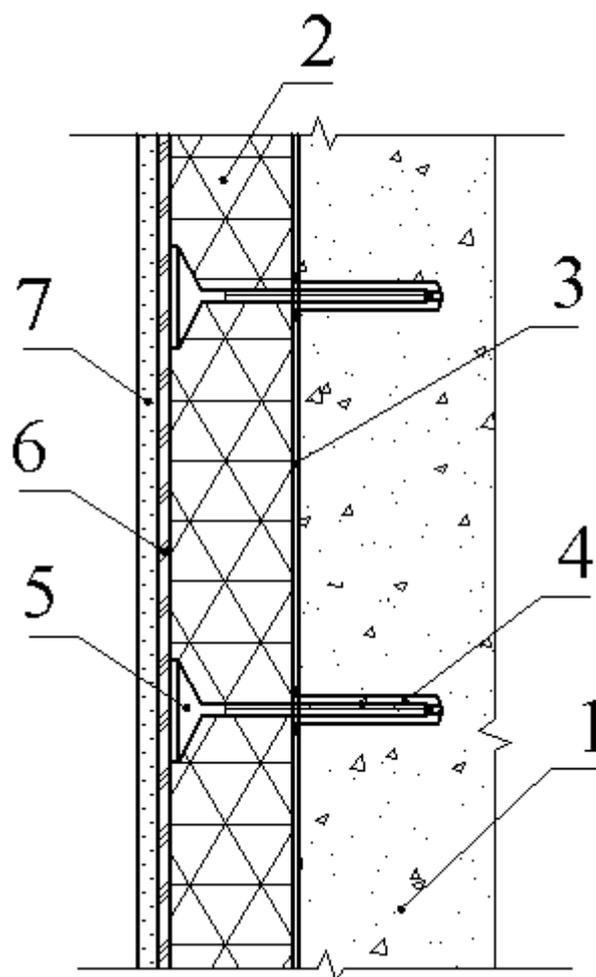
Схема наружной стены с эффективной теплоизоляцией с оштукатуриванием фасада:
